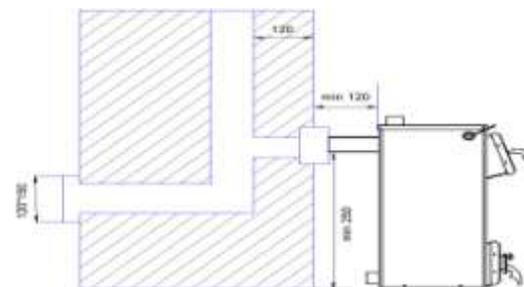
а. Устройство сажесборника и ревизионного окна при расположении дымохода в шахте (вид сбоку)
